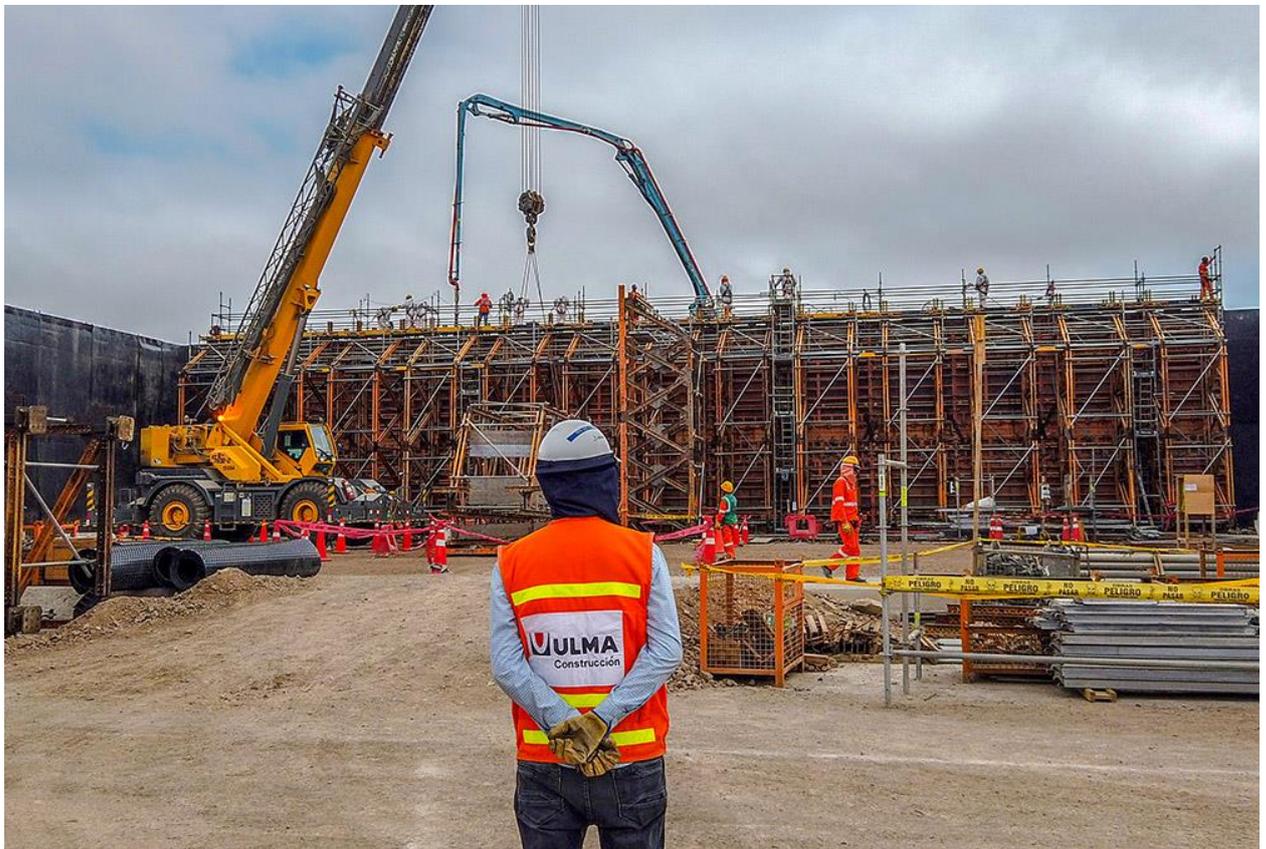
Proyecto de construcción industrial (ULMA, 2018).
